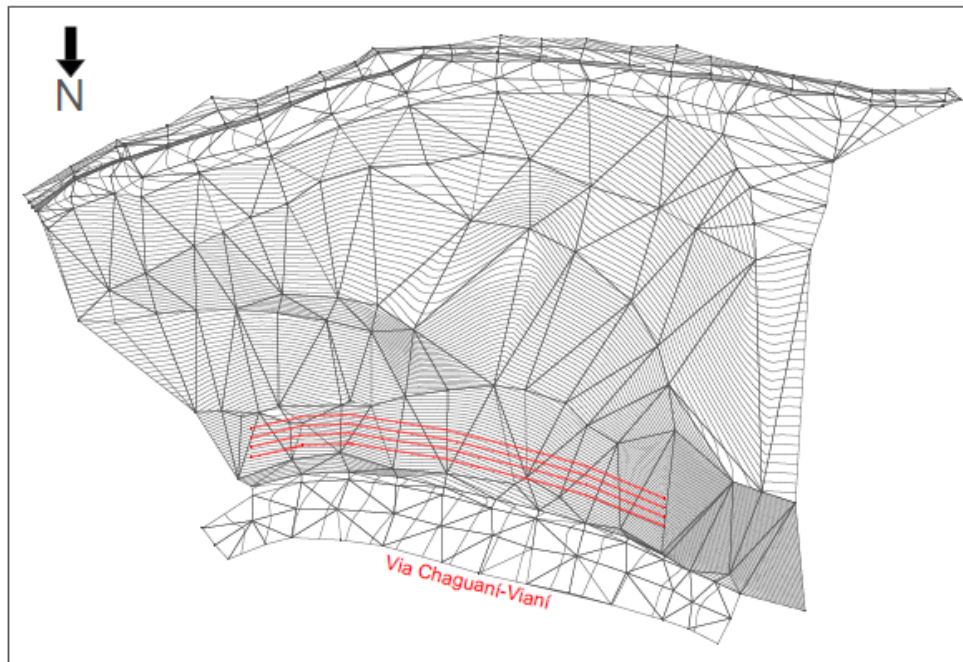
Vista en planta ubicación de trinchos. Fuente: Propia
